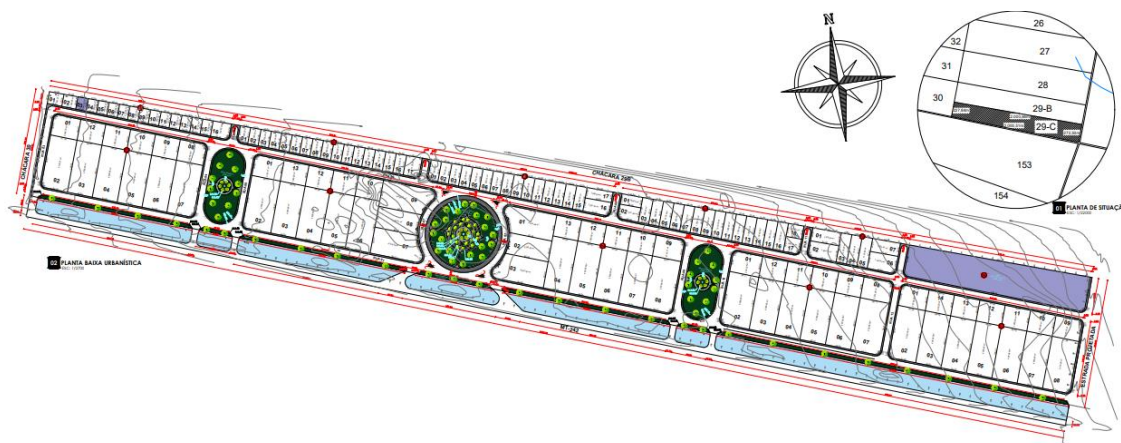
Planta Urbanística do Projeto de Loteamento.
